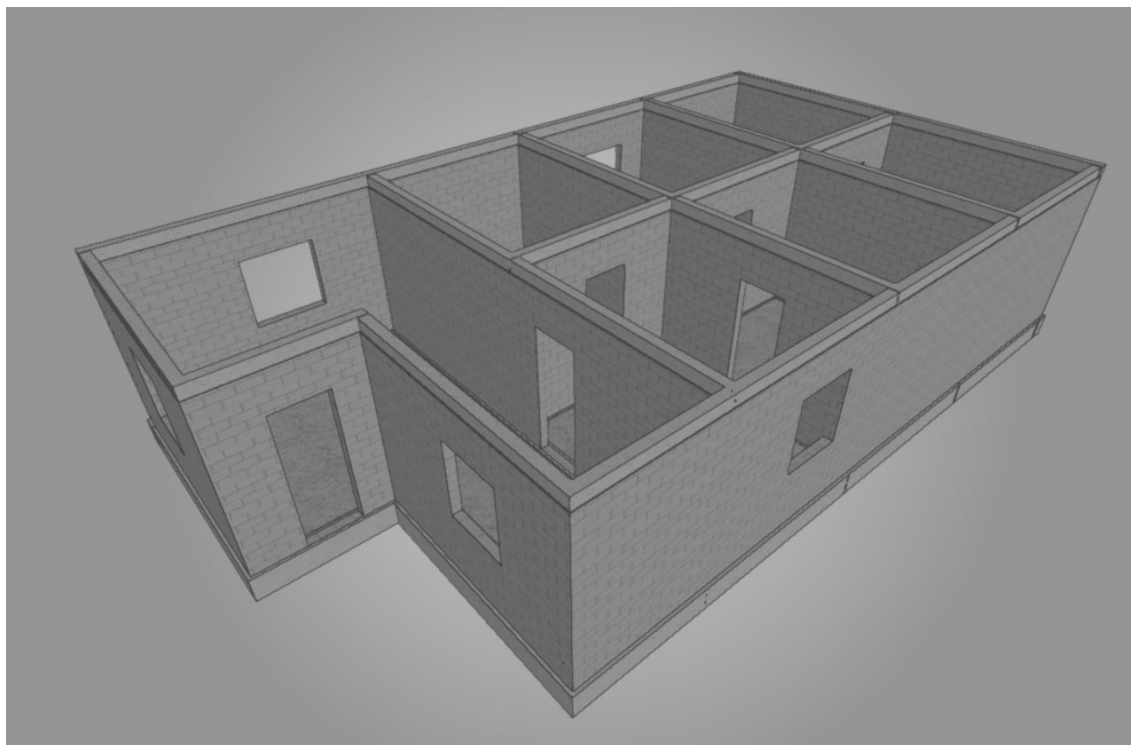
Distribución de muros de planta baja - Fuente: elaboración propia.
